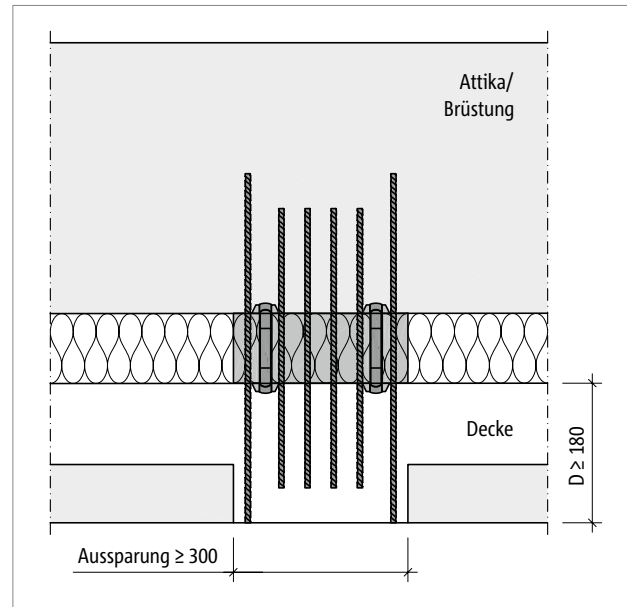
Schöck Isokorb® CXT Typ AP: Ansicht; Mindestabmessung Aussparung Elementplatte
